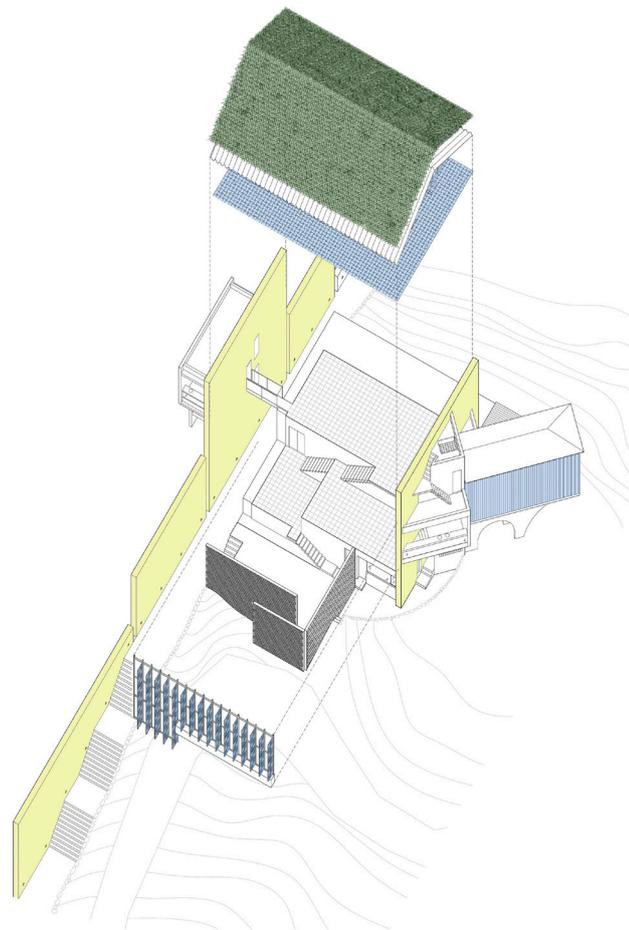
Axonometría explotada con elementos de madera de teca en azul, tejido de coco en verde y muros delimitadores de hormigón en amarillo.
